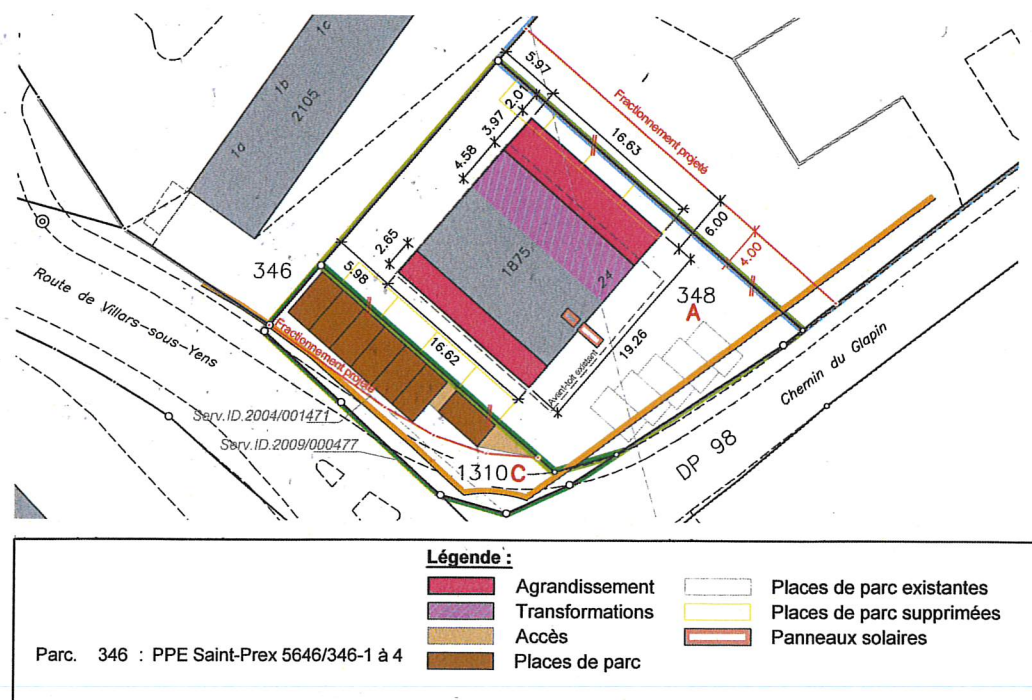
, Plan de situation du projet d'agrandissement de la halle sise sur la parcelle n° 348 (situation au 11 janvier 2024)
